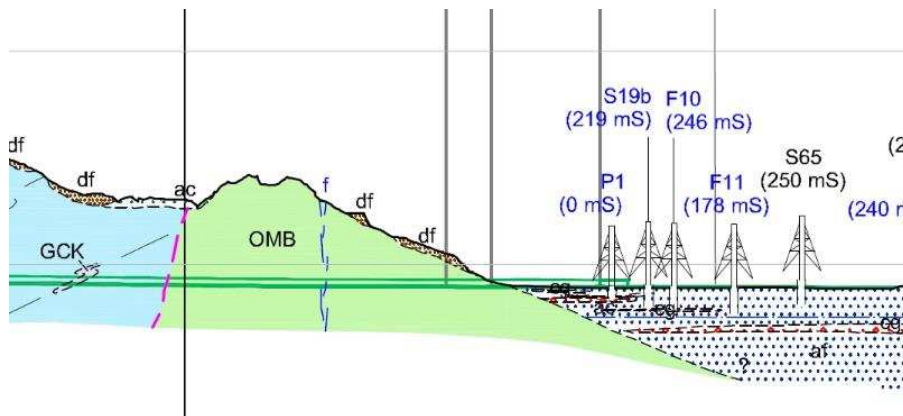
Profilo geologico della zona interessata dalle rocce verdi
